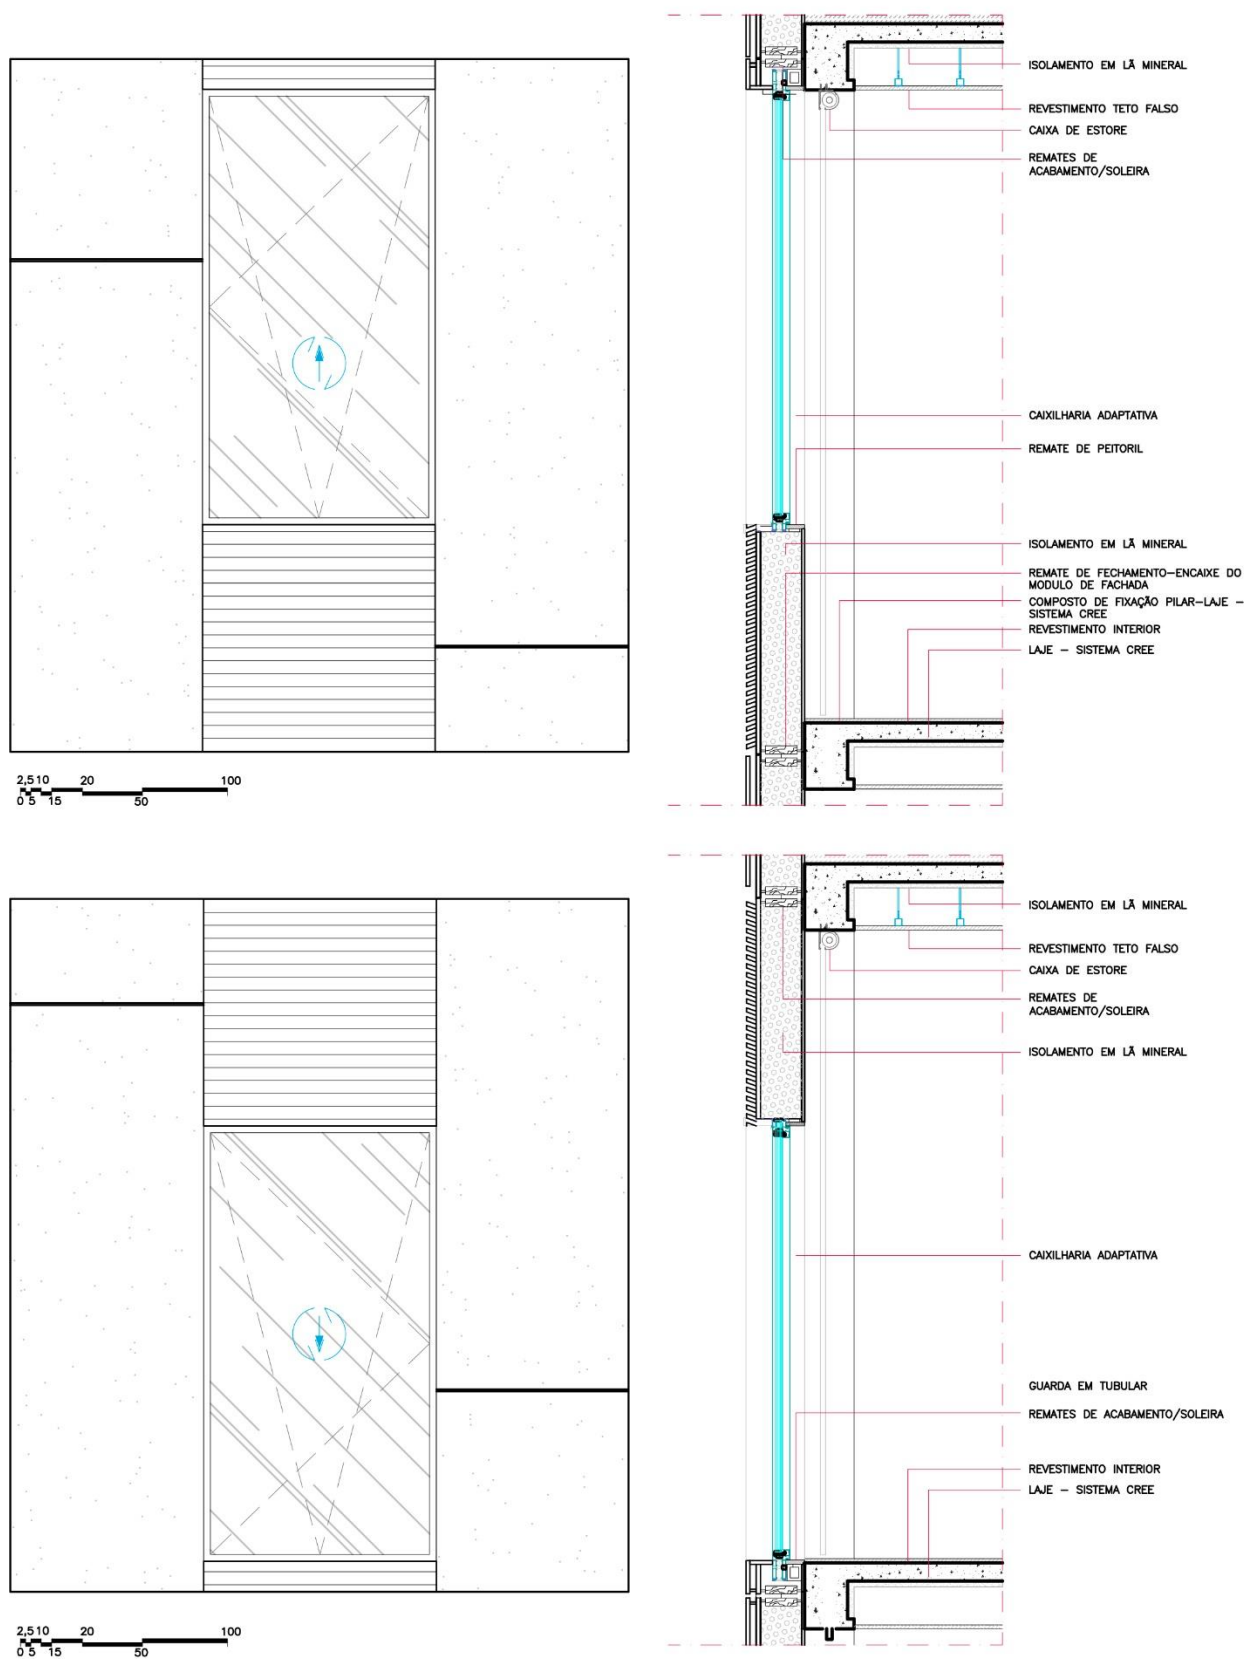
Pormenor De Rotação Da Fachada Adaptativa – Fonte: Autoral
